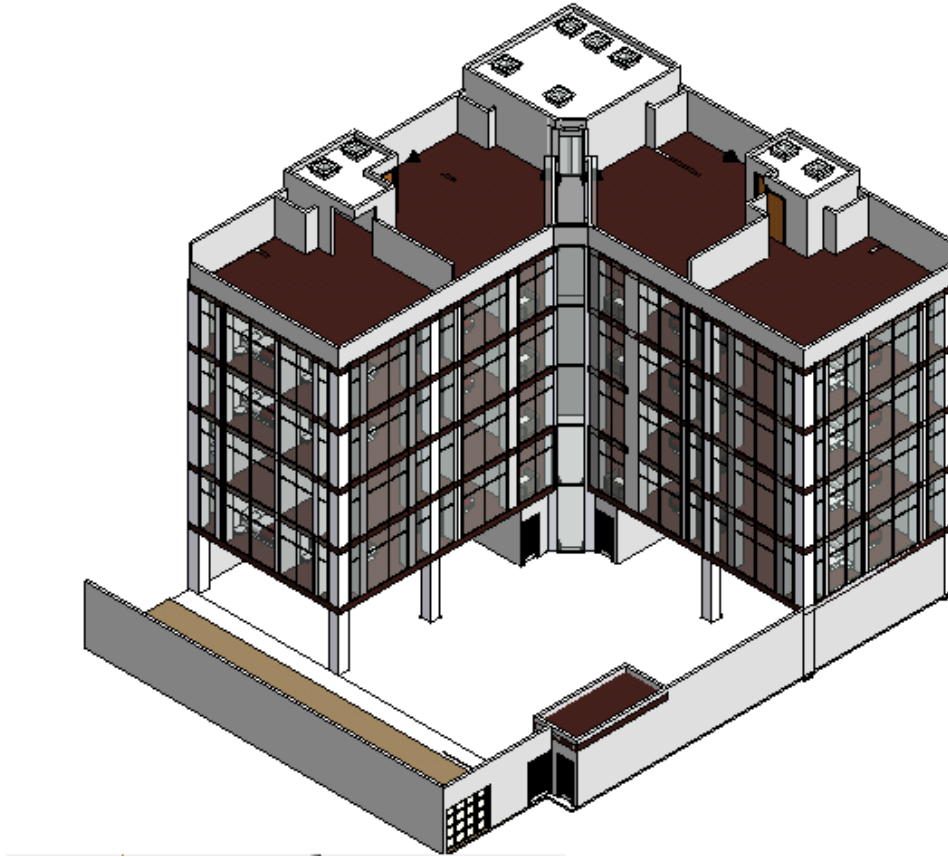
Modelo Arquitectónico Torre 1 (Autoría propia).
